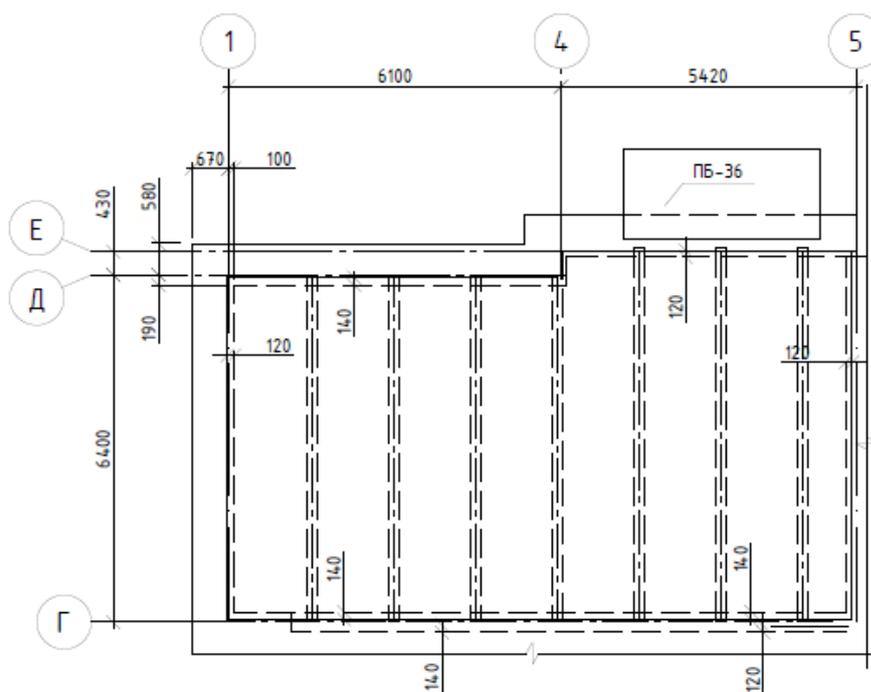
Конструктивная схема монолитного ребристого перекрытия.
